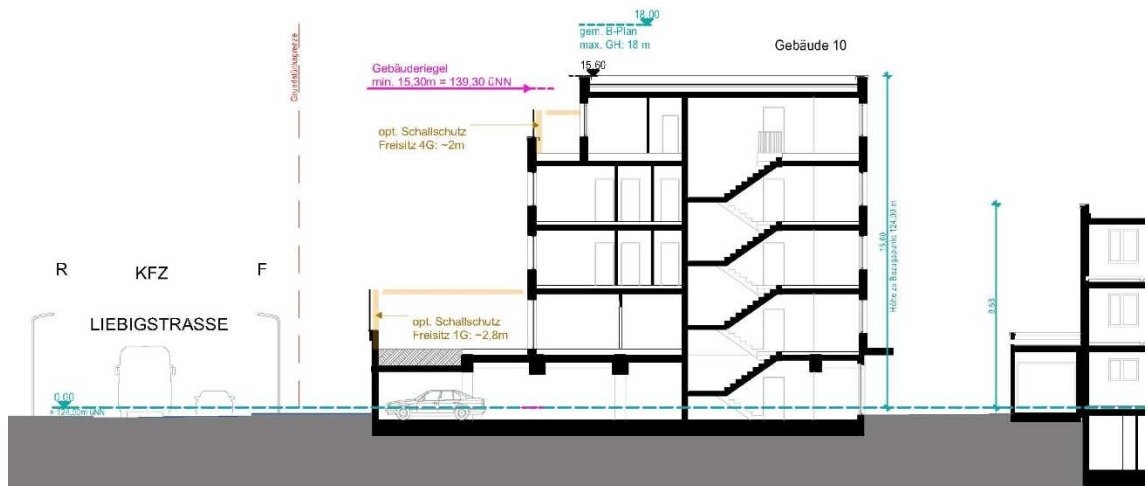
Schnitt West-Ost, Bereich Gebäude 10 mit Schallschutz Außenwohnbereiche auf Garagengeschoß und Dachterrasse, Stand Oktober 2019
